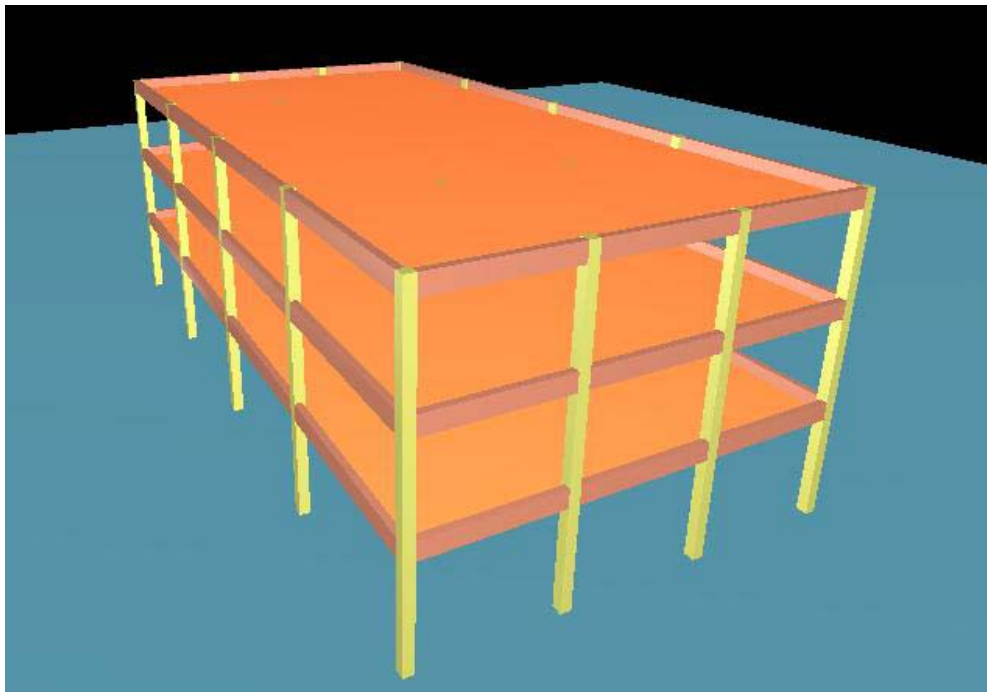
Perspectiva: pavimentos de estrutura do edifício tipo A
